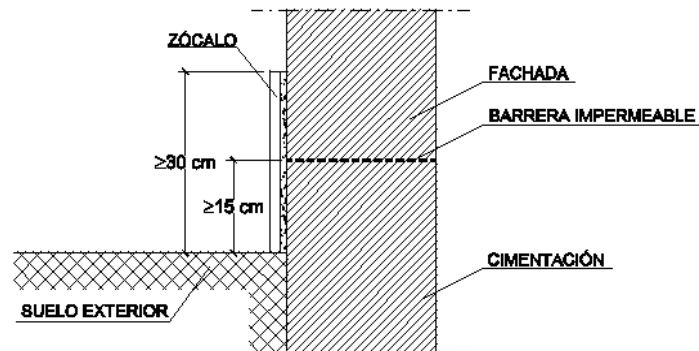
Ejemplo de arranque de la fachada desde la cimentación
